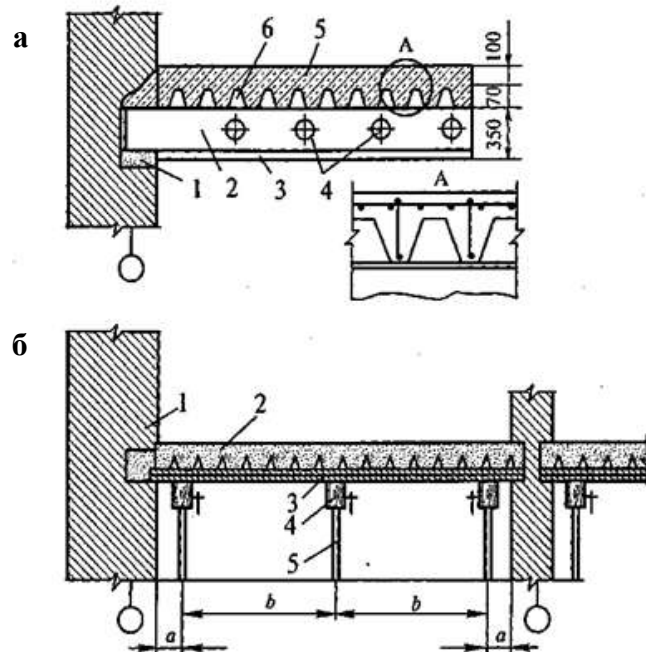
Схеми зведення перекриттів в незнімній опалубці:
